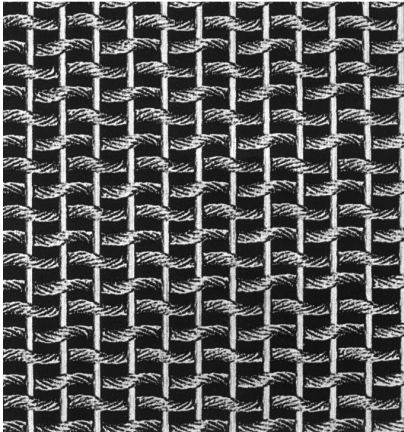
Londra Danimarka Büyükelçiliği'nde kullanılan lamine panel detayı [6]
